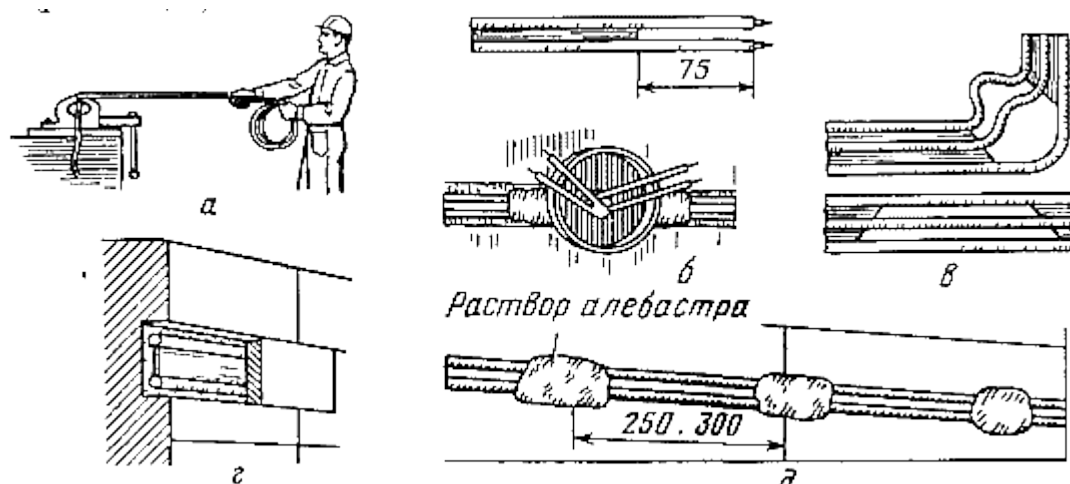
Прокладка проводов скрытых электропроводок:
